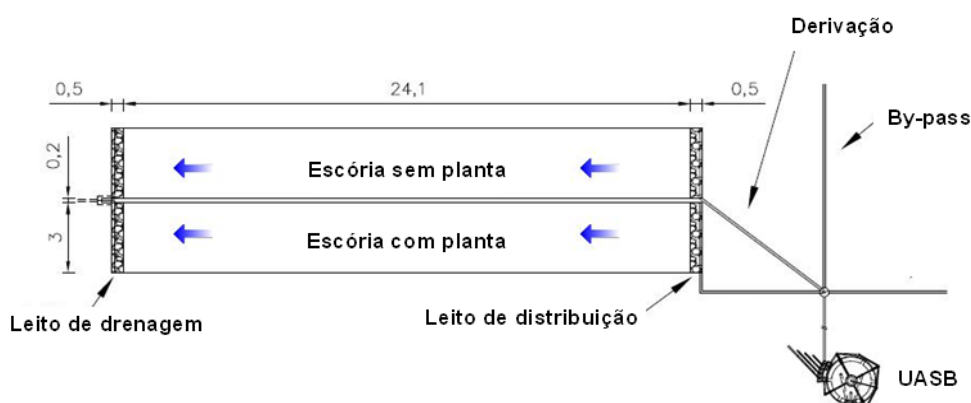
Planta do sistema de *wetlands* horizontais subsuperficiais
